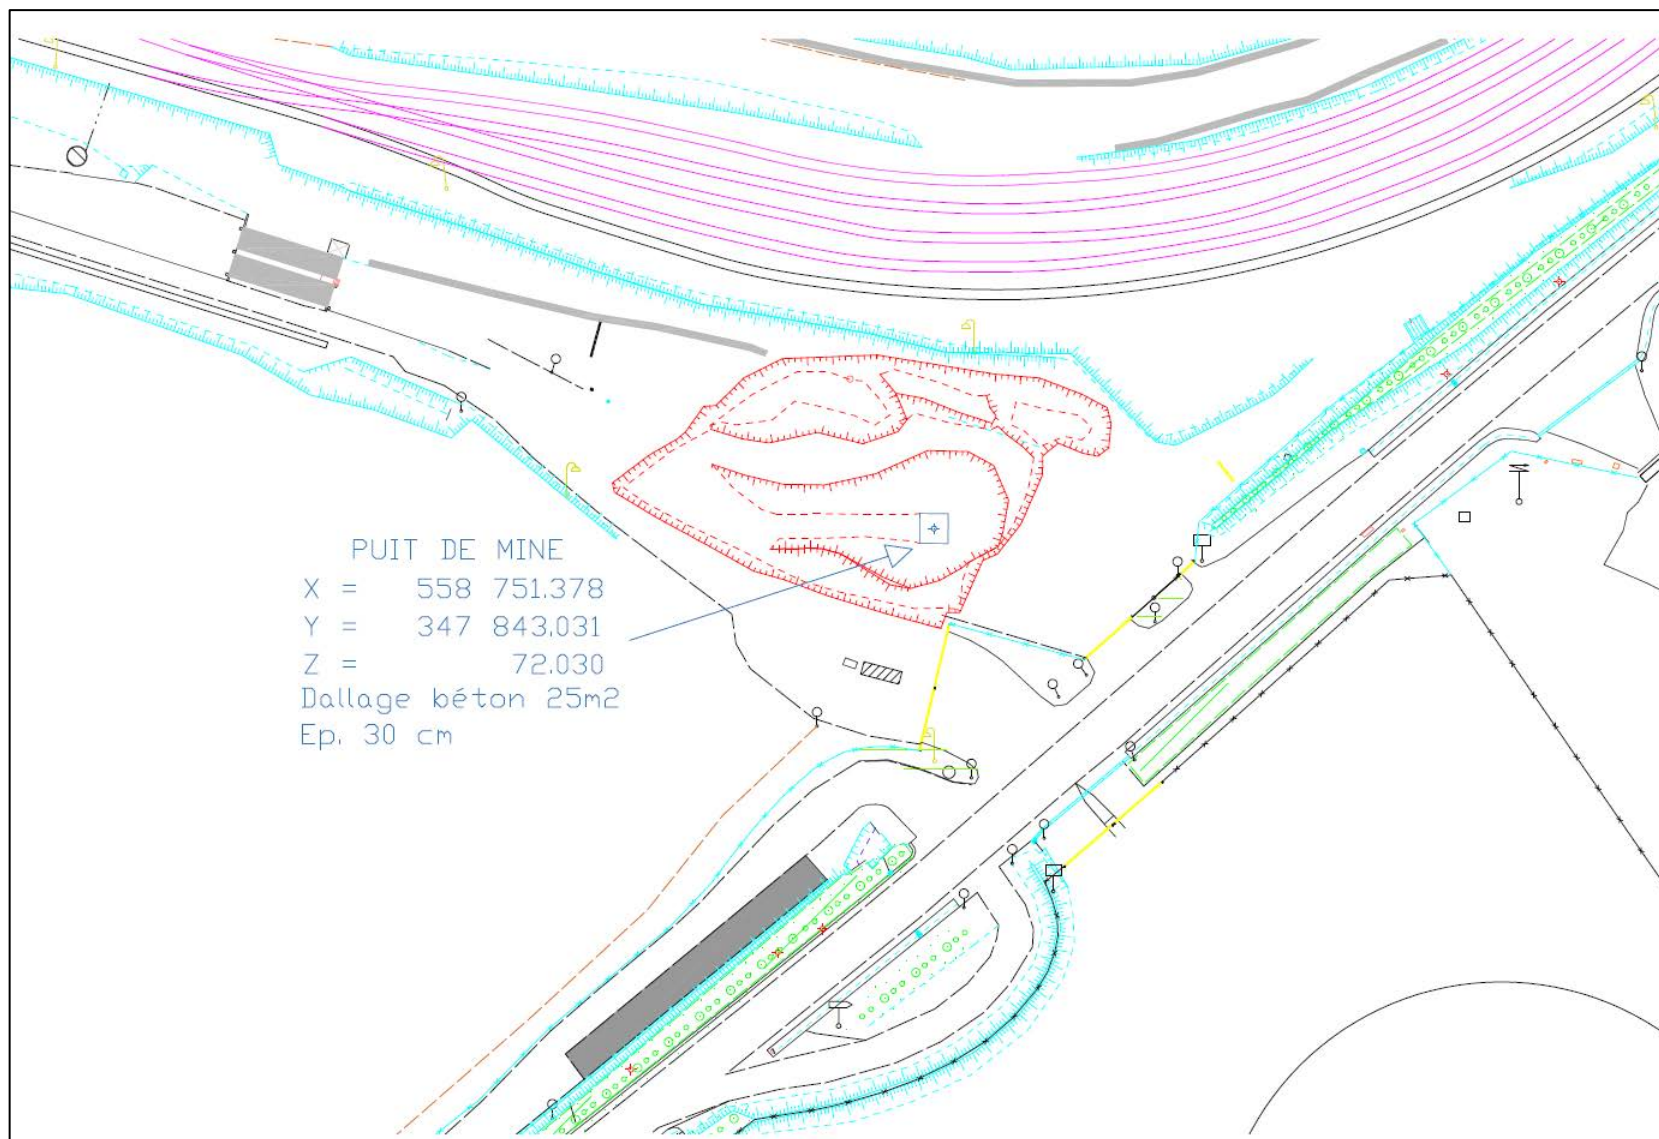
Plan de localisation fourni par les Carrières du Boulonnais avec les caractéristiques finales de la dalle béton
